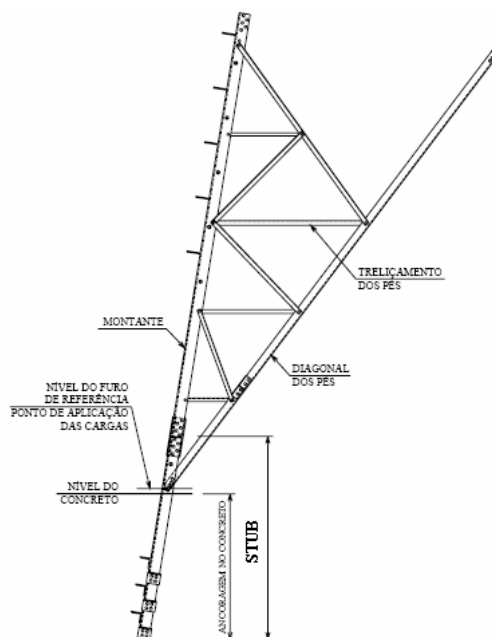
Ligação entre a torre autoportante e a fundação em concreto, com materialização do ponto de aplicação dos esforços (Garcia, 2005).
